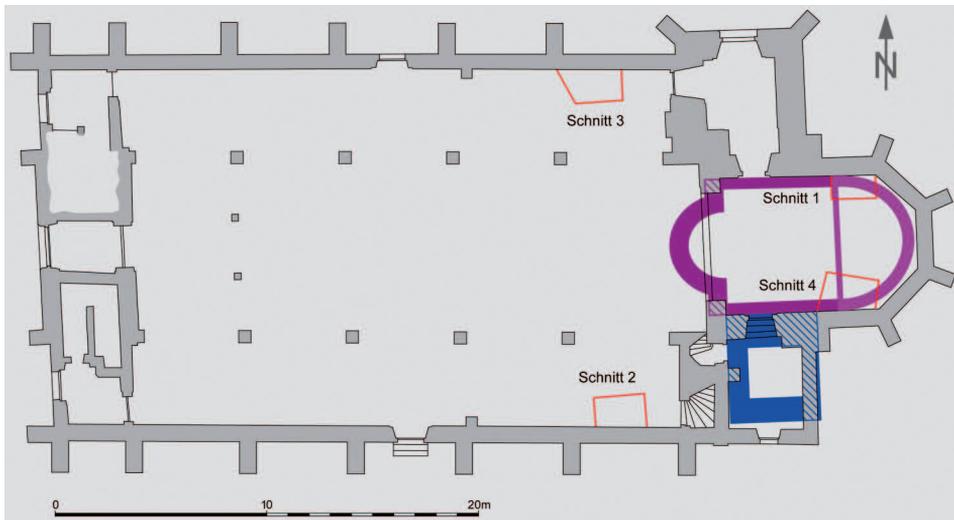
Grundriss der ev. Kirche Eichstetten a. K. mit den beobachteten Schnitten und rekonstruierten Vorgängerbauten.
